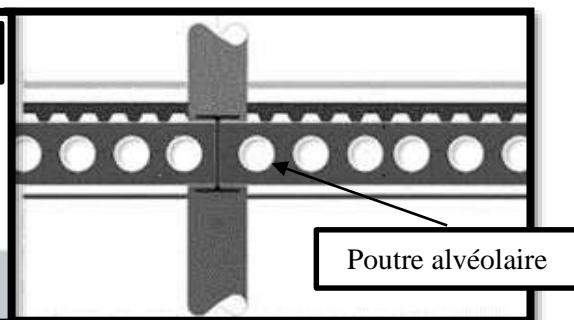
Coupe sur plancher collaborant avec poutre alvéolaire de 110 cm de hauteur
